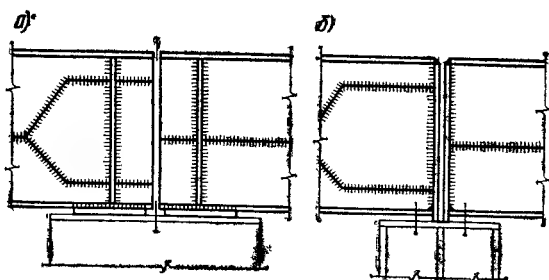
Опорные узлы стропильных балок из сквозных двутавров
